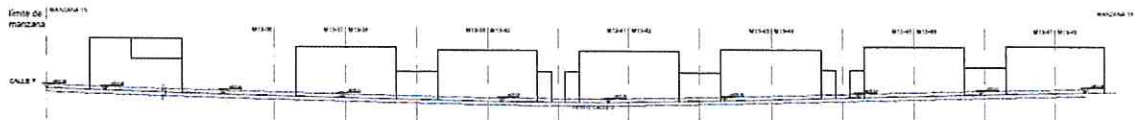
Sección Calle 2. Fuente: Elaboración propia.
